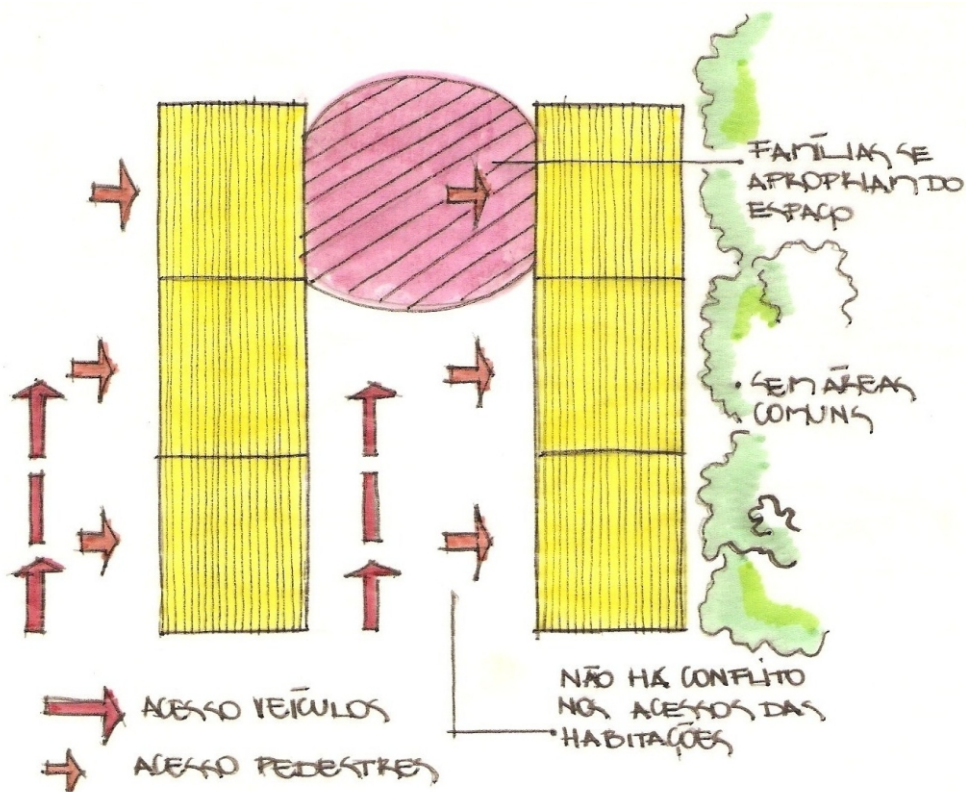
Planta Baixa. Análise Assentamento Provisório no Japão.
